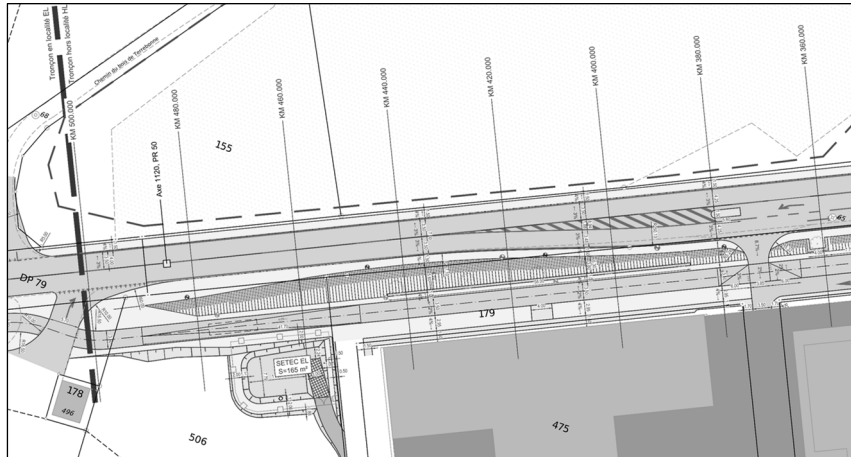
situation du projet de la partie hors localité pour la section du profil 360 au profil 500
